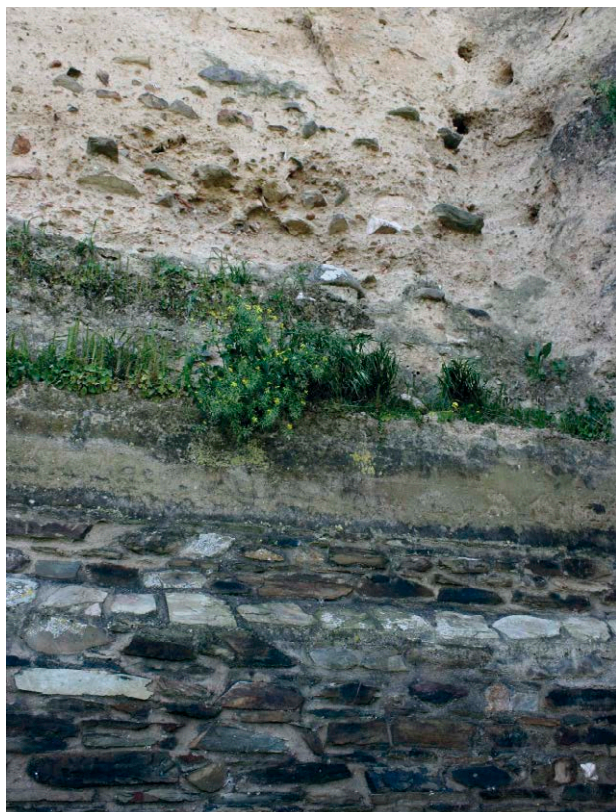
Erosión de la tapia provocada por humedad capilar en un paño de la muralla donde se construyó un nuevo zócalo de mampostería
